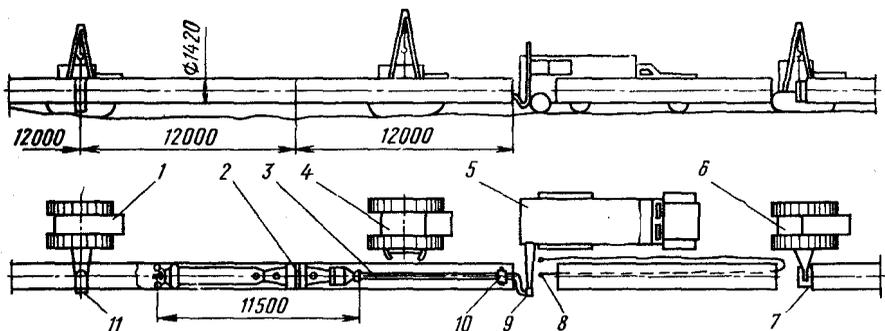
Схема сборки и сварки магистрального трубопровода с помощью внутритрубной машины:
